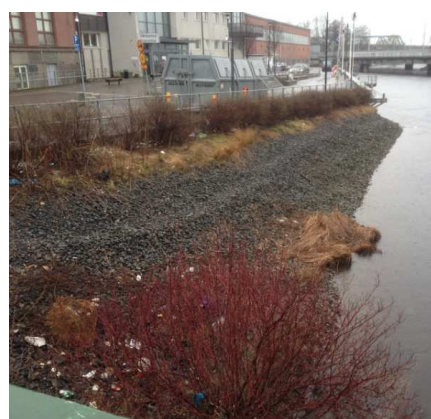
Erosionsskydd av bergkross strax utanför planområdet.
